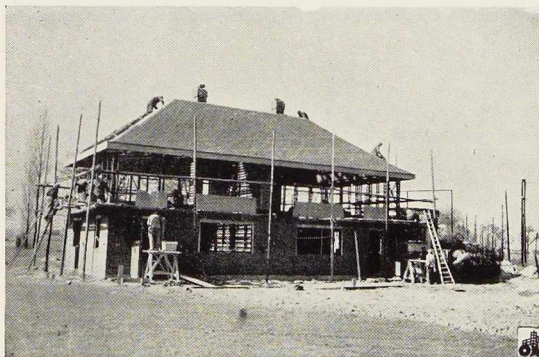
Vue d'une maison « Trusteel » en cours de construction. On notera la construction simultanée des murs extérieurs et de la toiture.
